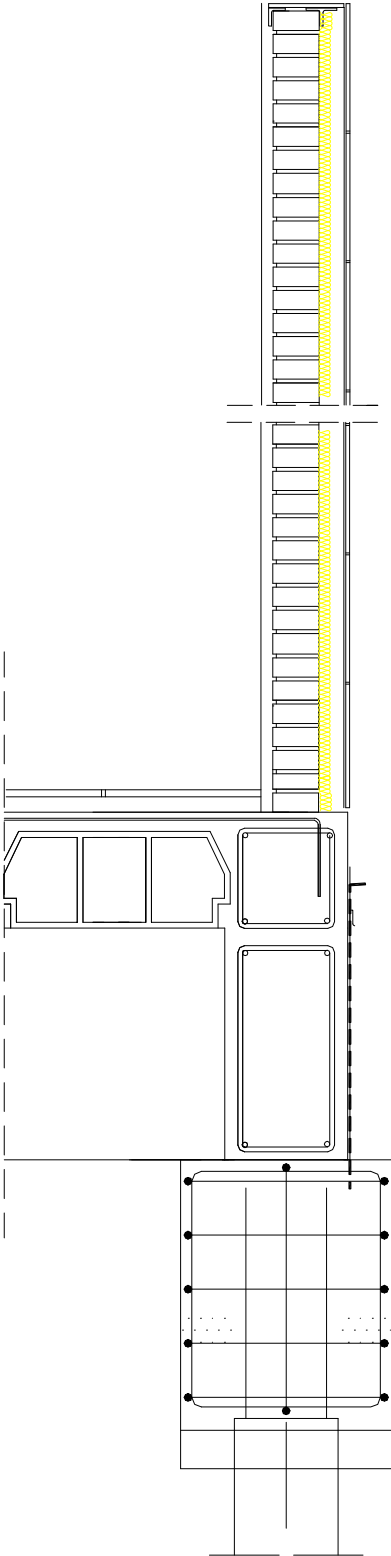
Sección constructiva de la fachada ventilada de juntas abiertas objeto de estudio
